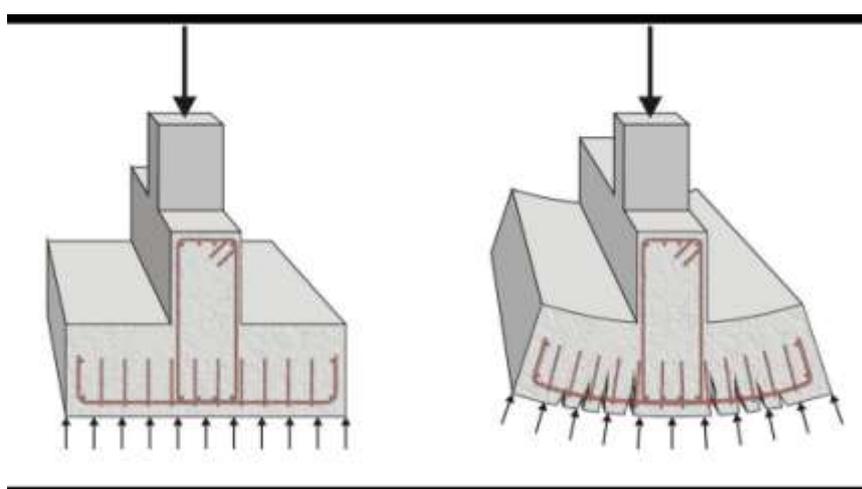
Смещение фундаментов сооружений при высоких нагрузках
